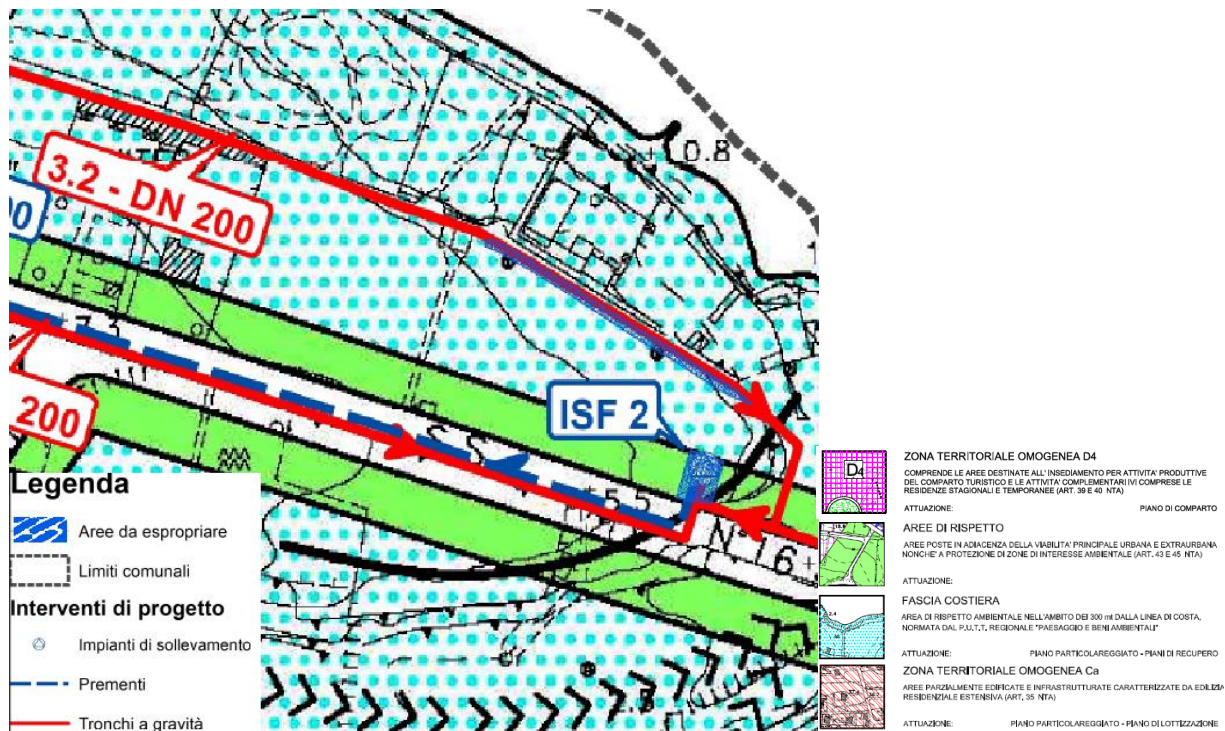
Sovrapposizione intervento tronco 3.2 e impianto di sollevamento compatto ISF2 con strumento urbanistico vigente
